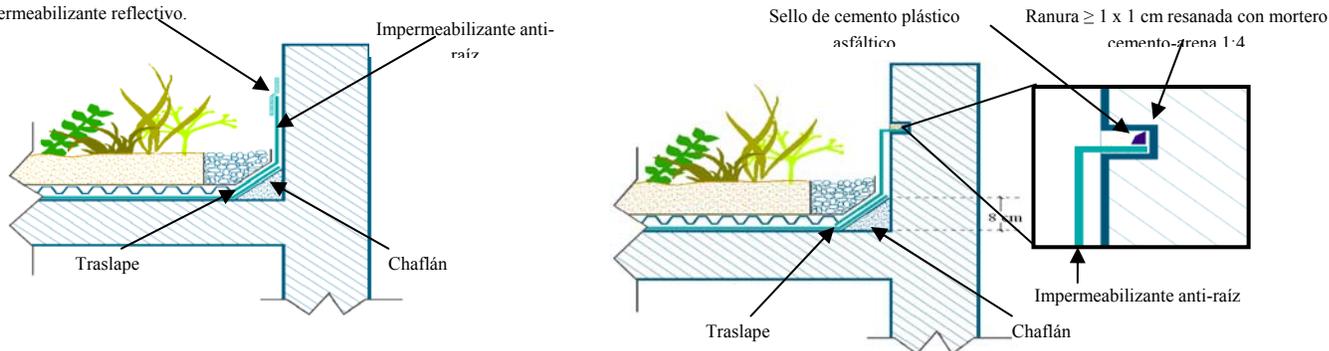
Impermeabilización con membrana prefabricada asfáltica en puntos de encuentro con pretilas y elementos emergentes perimetrales.
